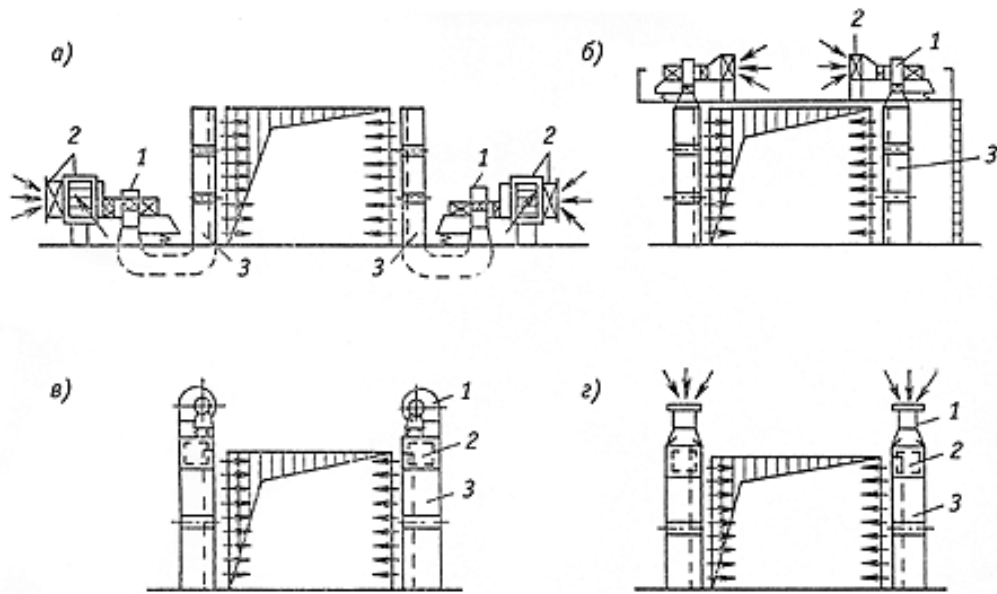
Схемы установки агрегатов завес шиберующего типа:
